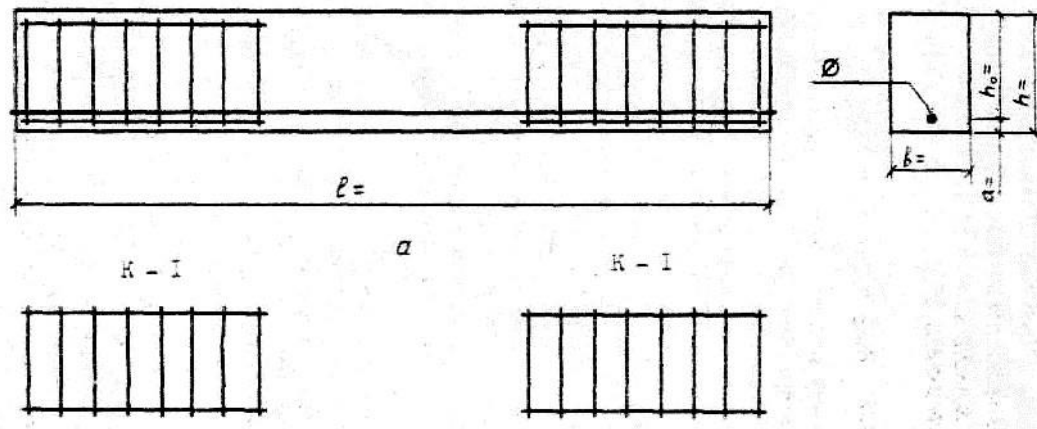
Геометрические размеры (а) и схема армирования балки (б)
